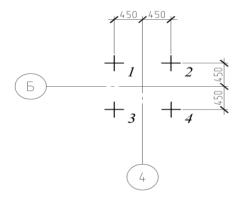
Пример оформления плана свай отдельного свайного фундамента
